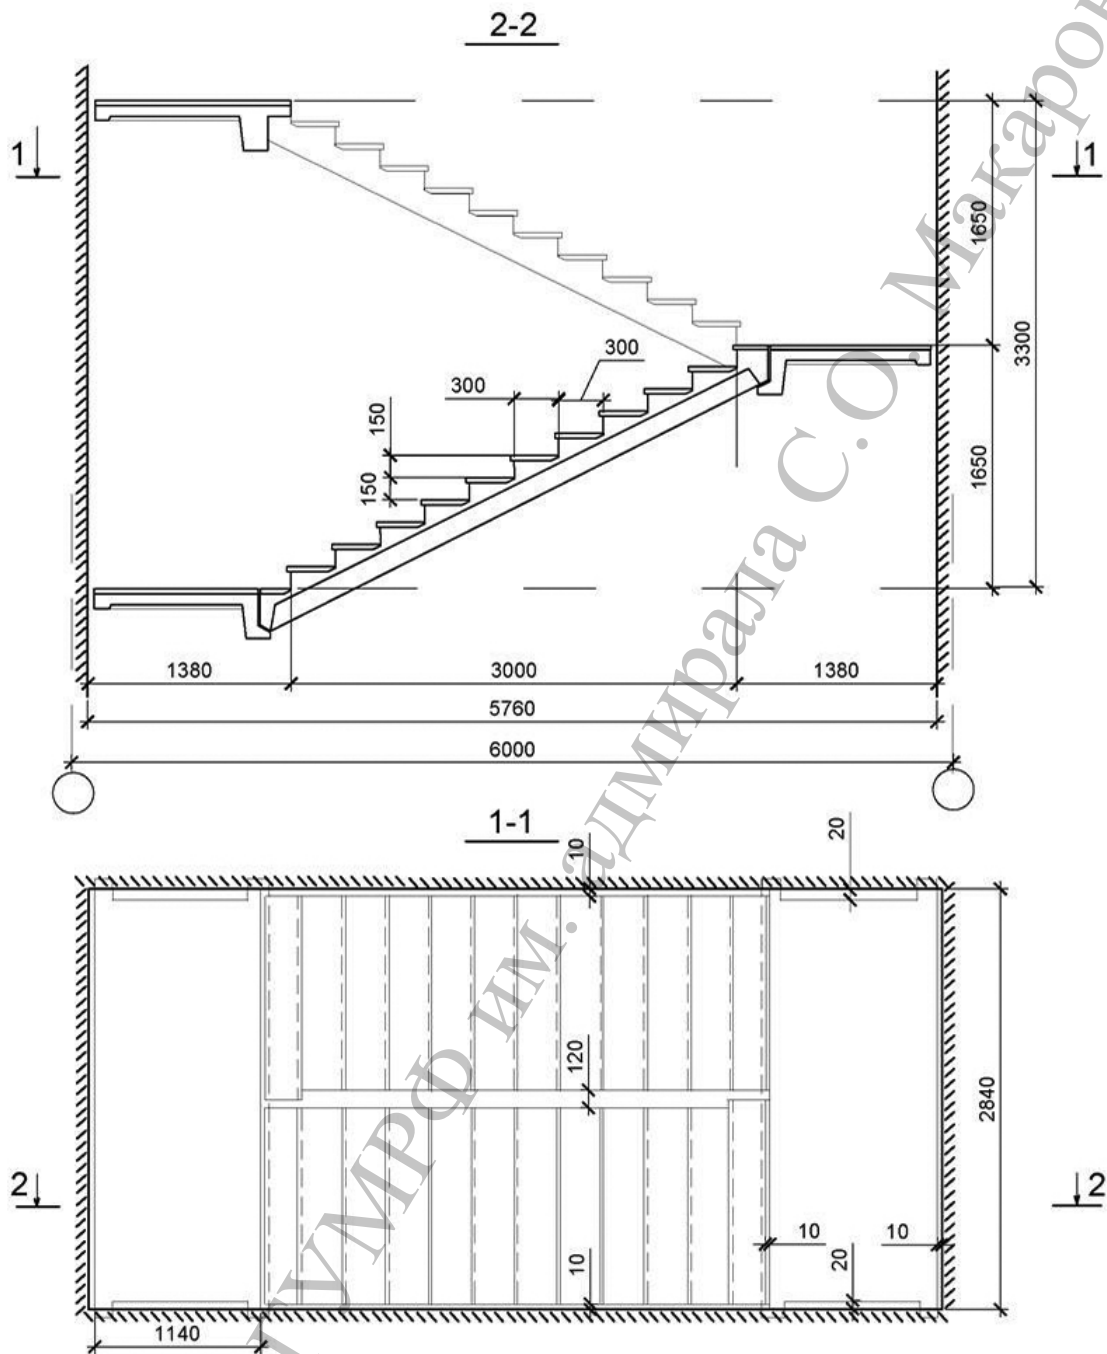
Сборная железобетонная лестница из маршей типа 2ЛМФ 39.14.17-5 и площадок ЛПФ 28.11-5
